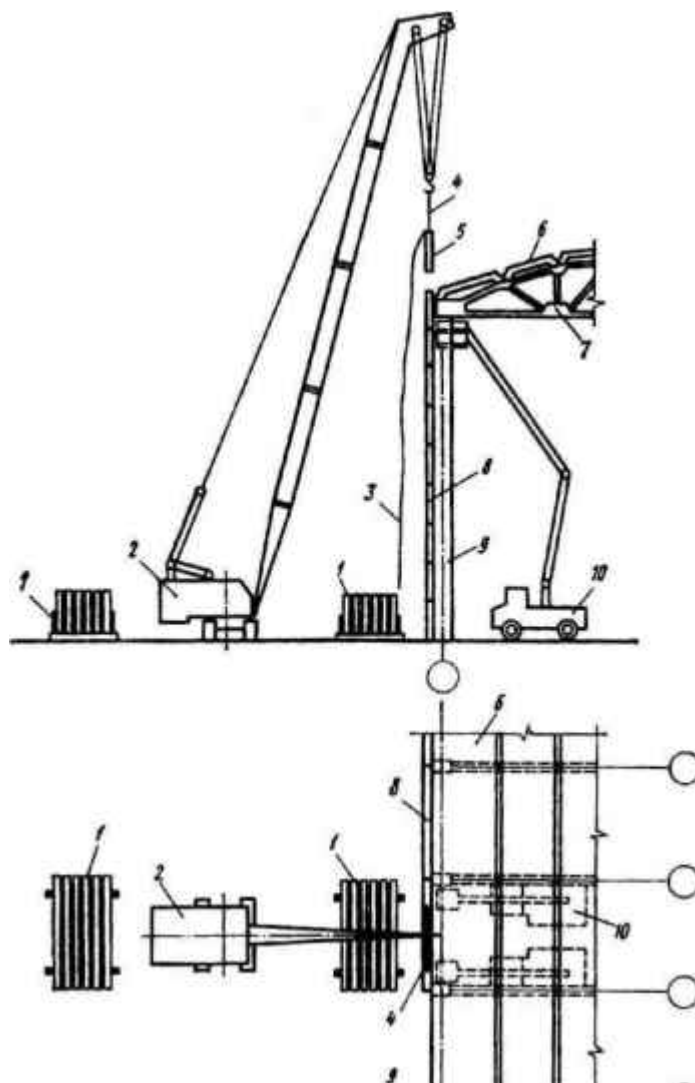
Схема монтажа стеновых ограждающих панелей, кран расположен между двумя кассетами: 1-кассета для складирования панелей стен; 2 - монтажный кран; 3 - оттяжка из пенькового каната; 4 - двухветвевой строп; 5 - панель стены; 6 - смонтированное покрытие; 7 - стропильная ферма; 8 - стеновое ограждение; 9 - колонна; монтажный гидроподъемник на автомобиле
